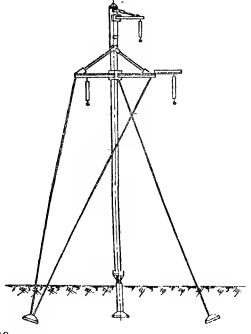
Угловая железобетонная повышенная опора на оттяжках.
